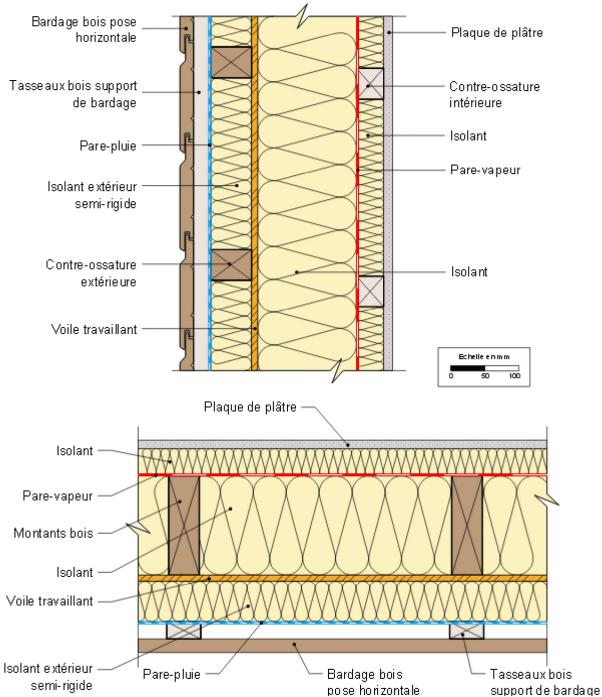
Doublage isolant par l'extérieur et par l'intérieur (coupe verticale en haut, verticale en bas)
